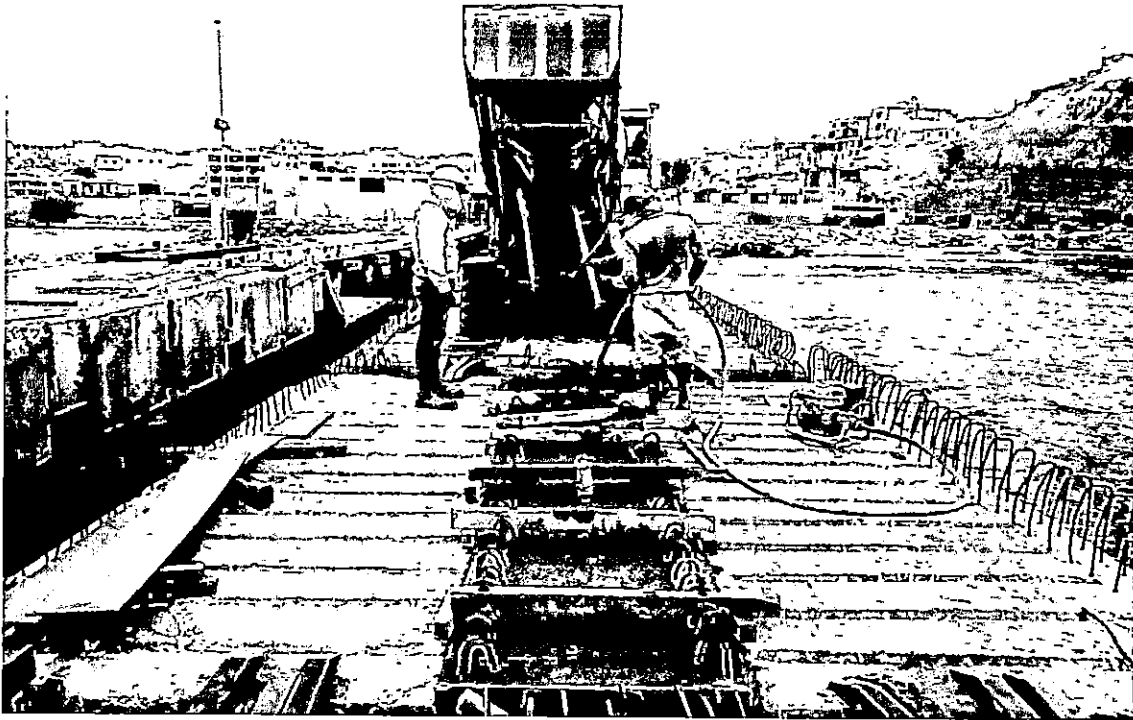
Concreto vaciados en juntas longitudinales del puente
